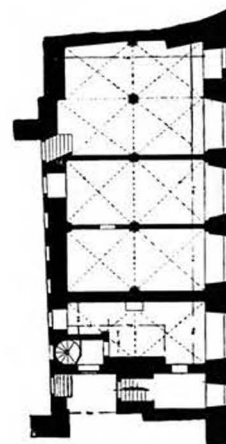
Schloß Altenburg, Kirchenflügel, Erdgeschoss
